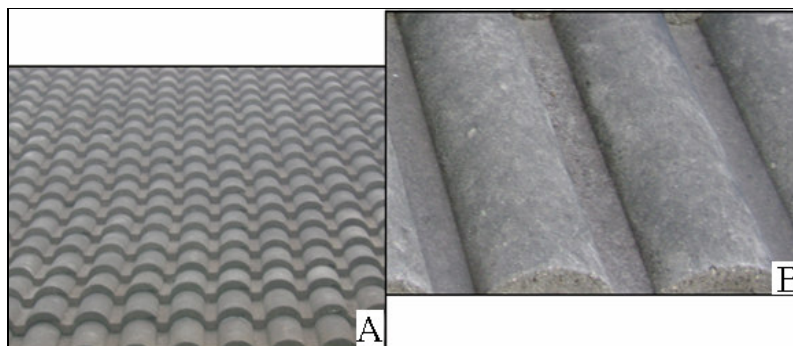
Cobertura predial utilizada para captar a precipitação (A), com detalhe das telhas em fibrocimento (B).
